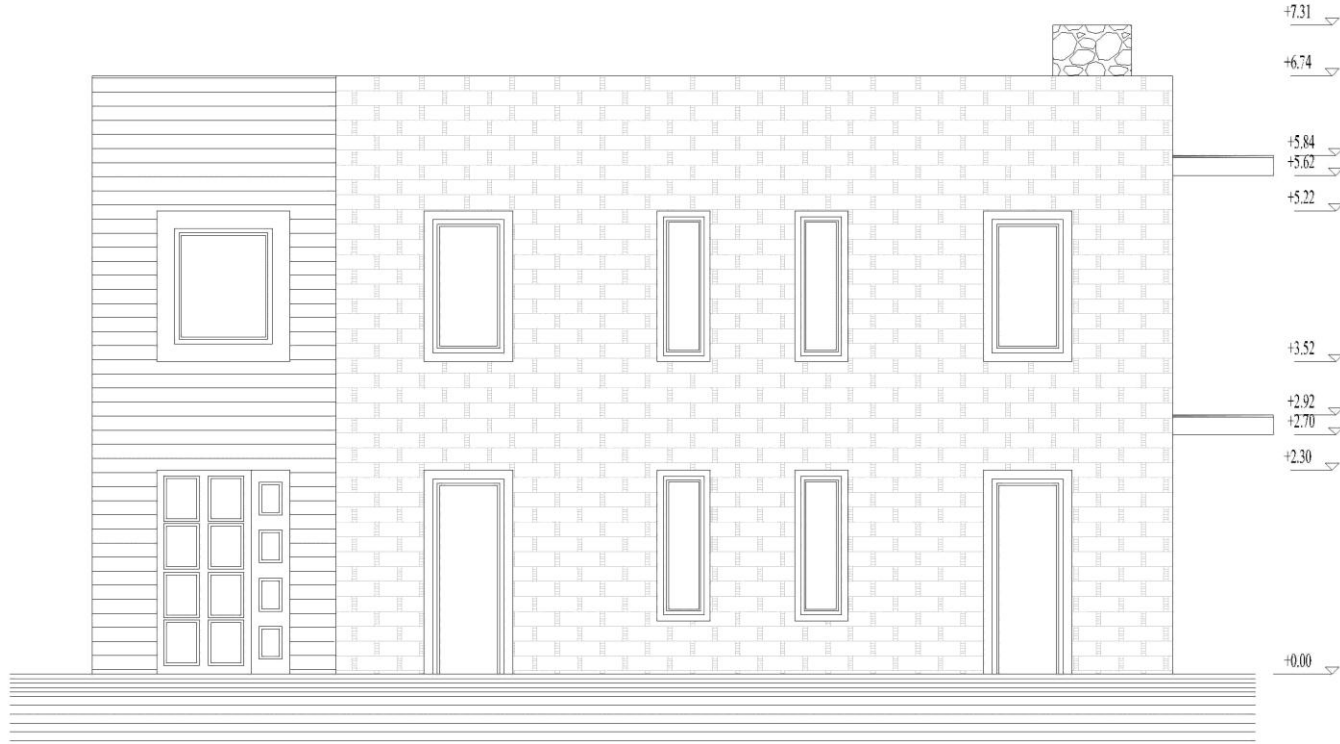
Betonarme sistem yapının ön cephe görünüşü
